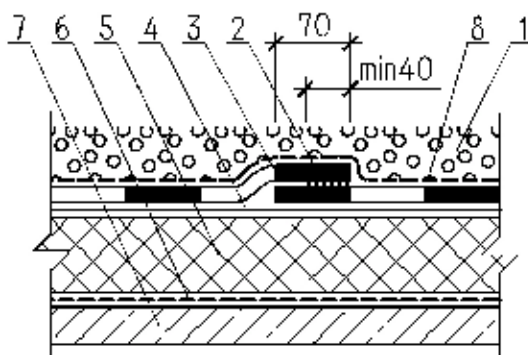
Условные обозначения: 1 – пригруз; 2 – сварка; 3 – Кровлелон; 4 – Геотекстиль; 5 – теплоизоляция; 6 - пароизоляция (по расчету); 7 - основание под кровлю: сборная стяжка или стяжка из цементно-песчаного раствора; 8 – противокорневой слой.
